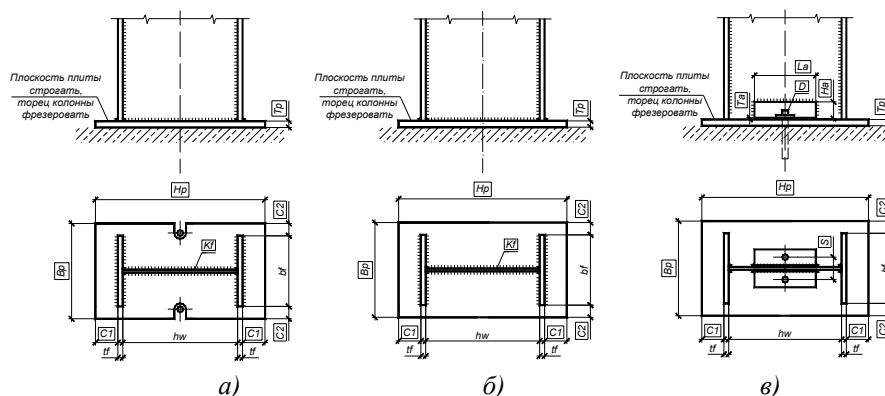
Типы конструктивных решений шарнирных баз колонн с фрезерованным торцом.
